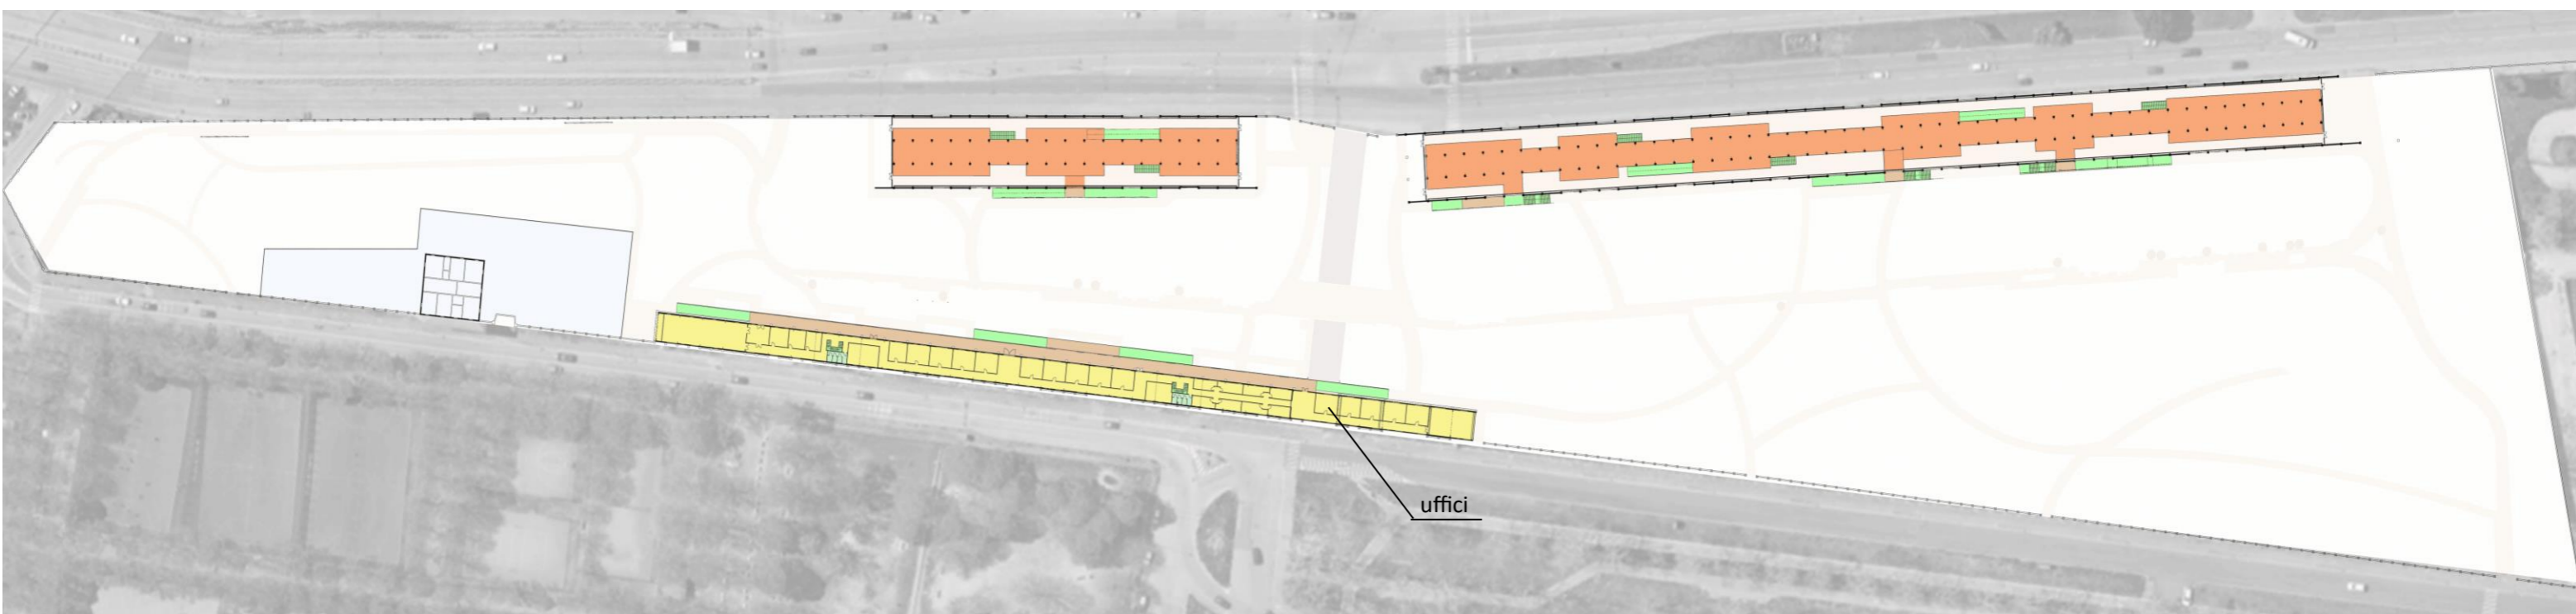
Planimetria delle destinazioni d'uso in progetto, piano primo. Elaborazione propria tramite software BIM e post-produzione.
